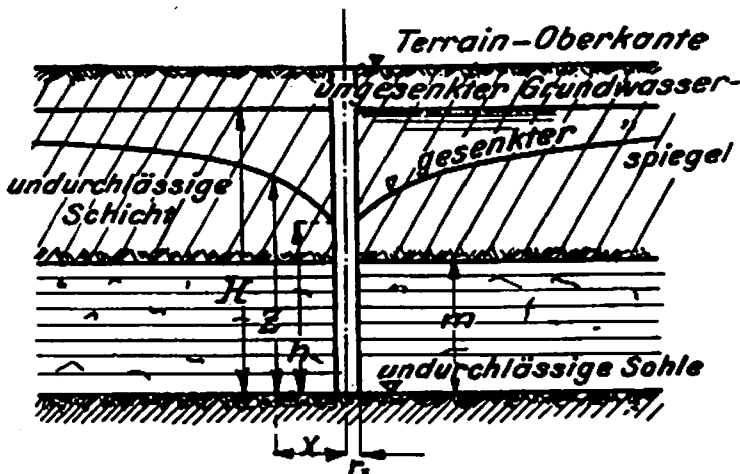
Brunnen im gespannten (artesischen) Grundwasser.
